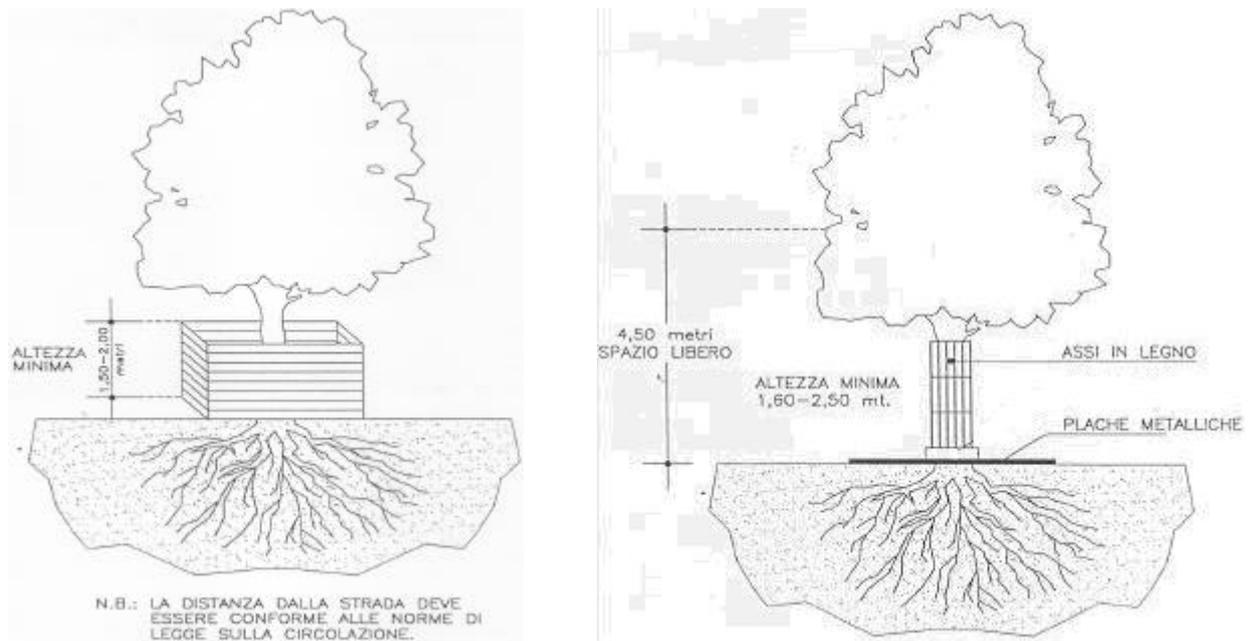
Protezione dell'albero attraverso la delimitazione dell'area minima di rispetto per alberature stradali con poco spazio.
